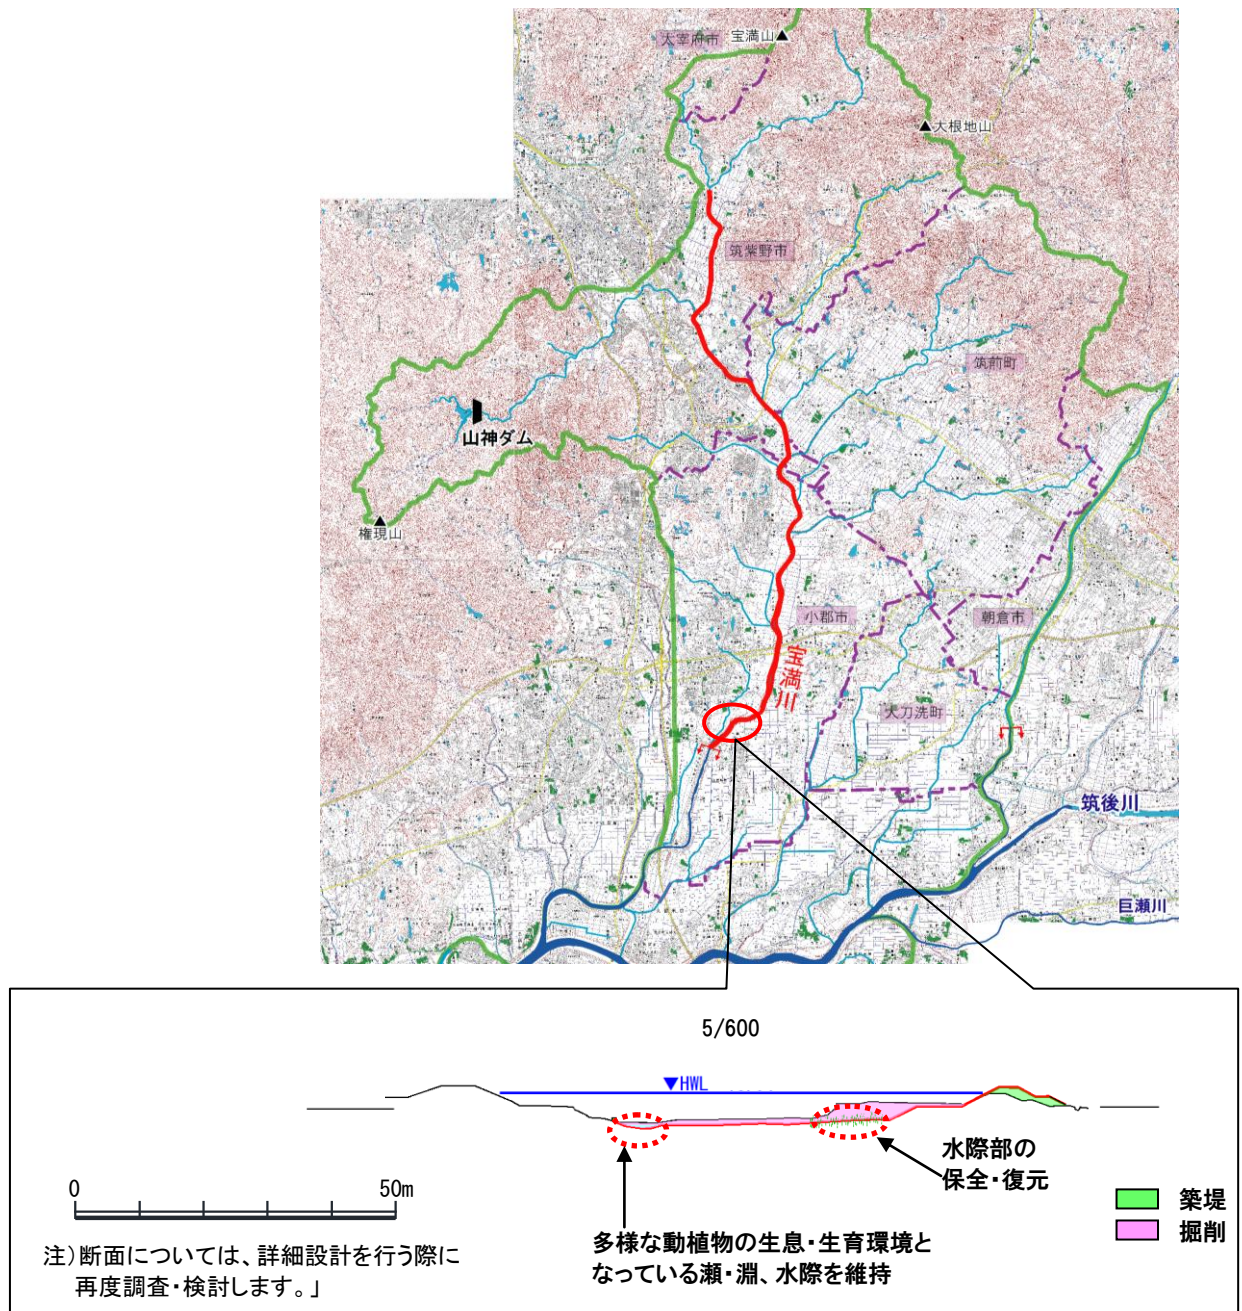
宝満川 整備計画区間平面図・代表横断面図
